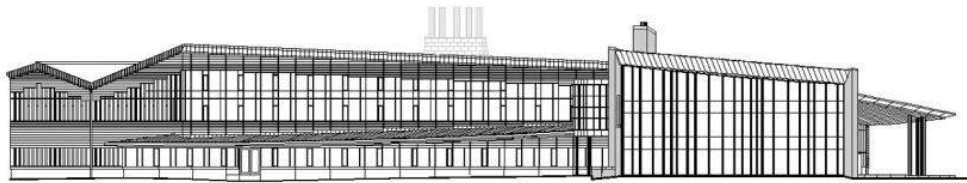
layout plan Cornell Ornithology Laboratory
